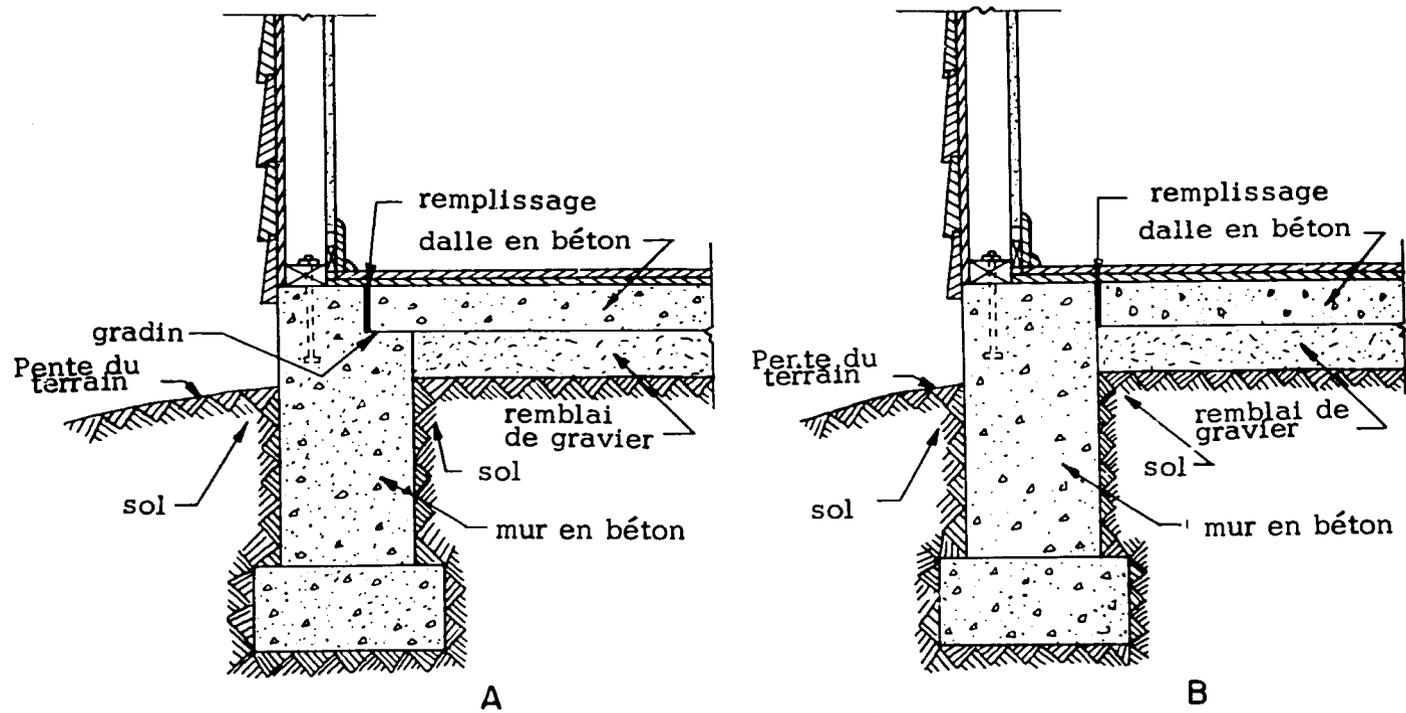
Construction sur dalle en béton flottante. A. — Le bord de la dalle repose sur le rebord du mur de fondation ; B. — La dalle flottante repose entièrement sur le sol.
